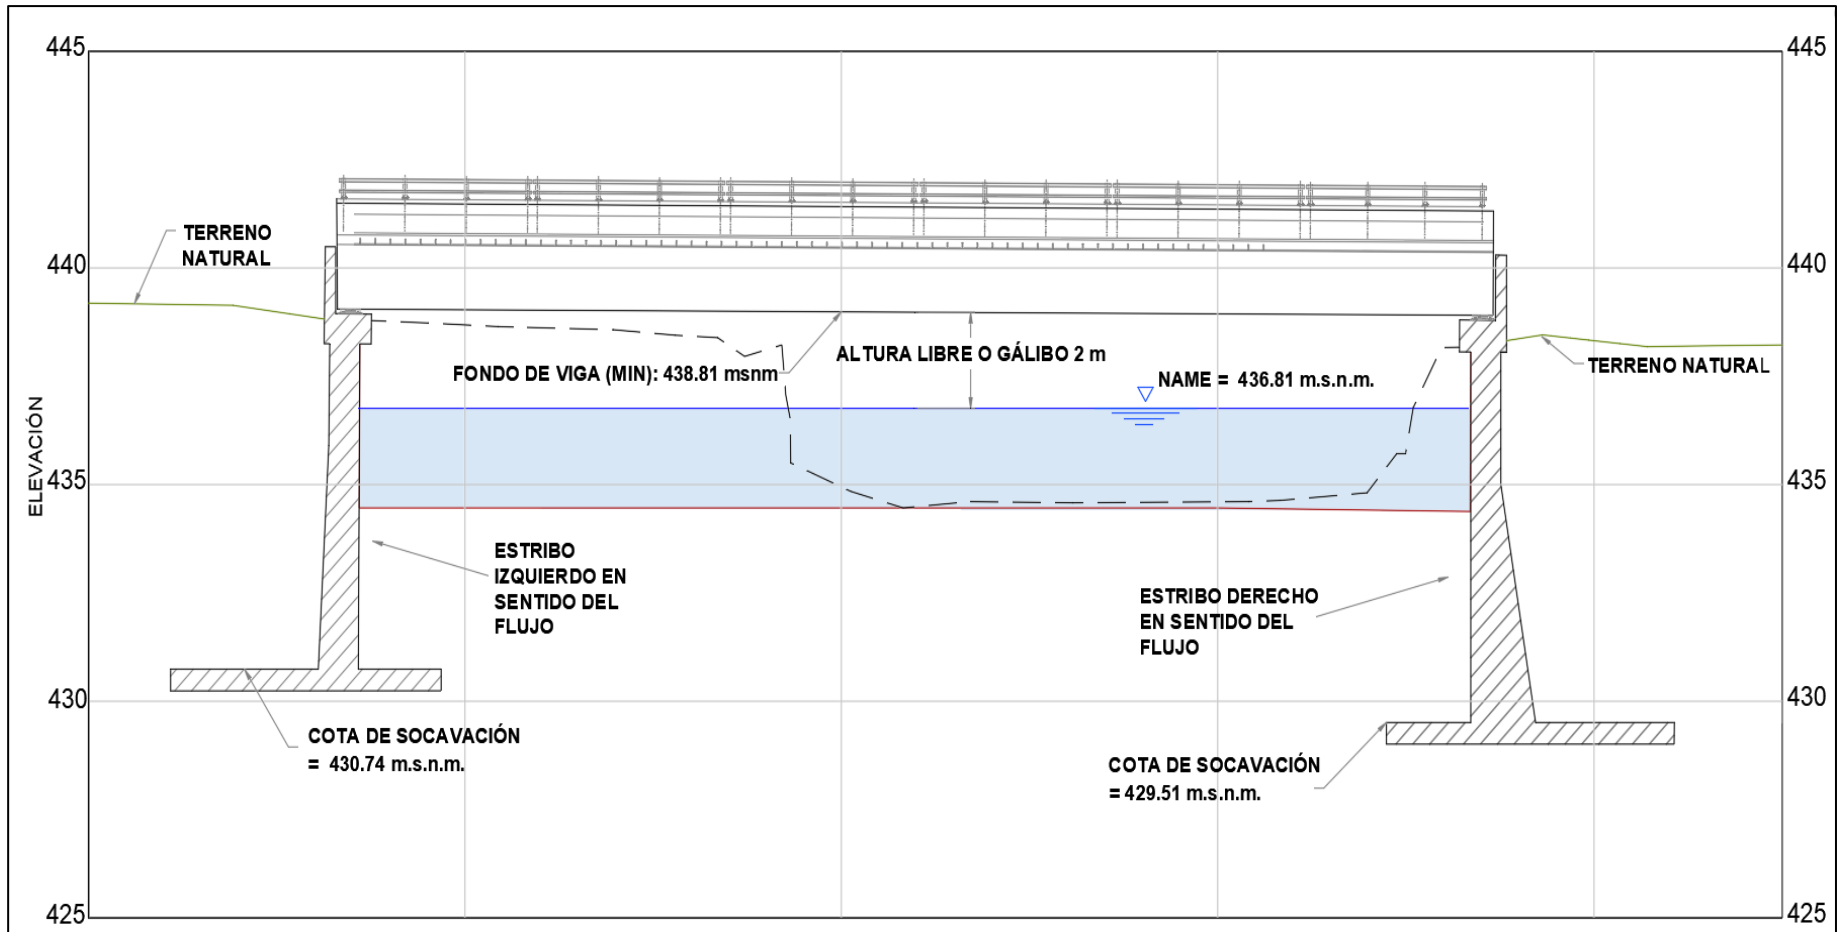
Sección con las dimensiones del puente proyectado Huáncar
